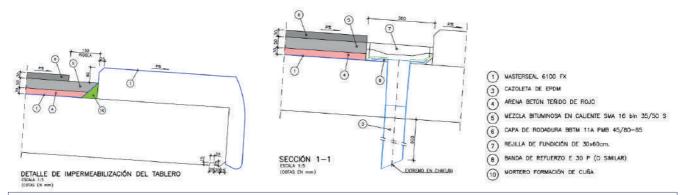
Detalles de remate de la impermeabilización y pavimento en general (izq.) y en zona de desagüe (der.).
